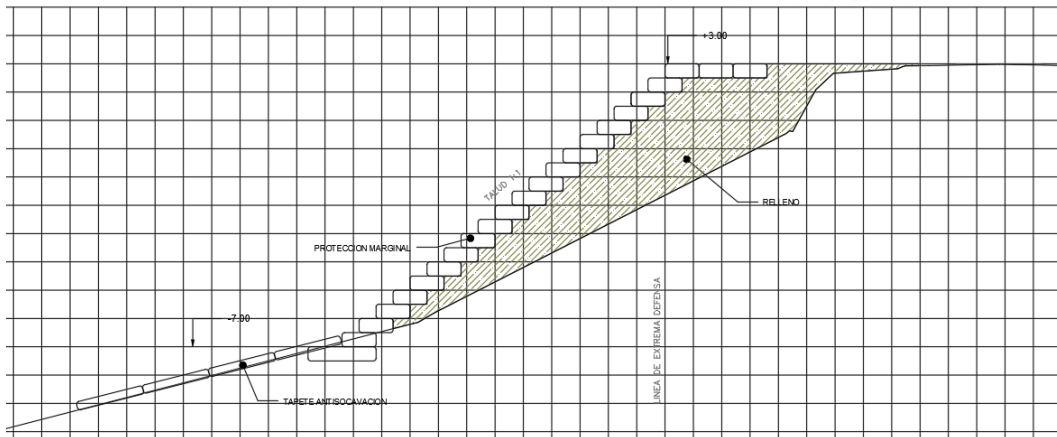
Sección transversal de la protección marginal en el cadenamiento 8+900.
